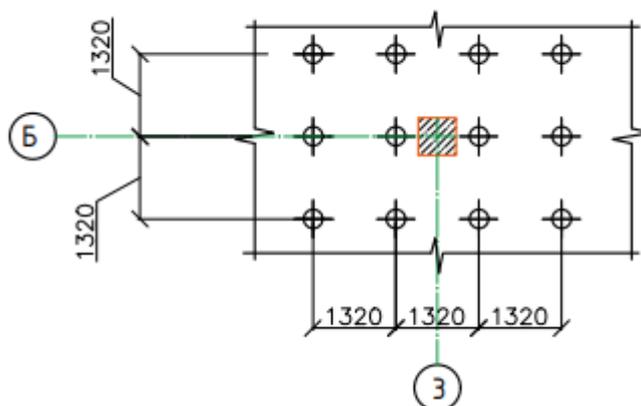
Схема расположения свай под фрагмент плитного фундамента
